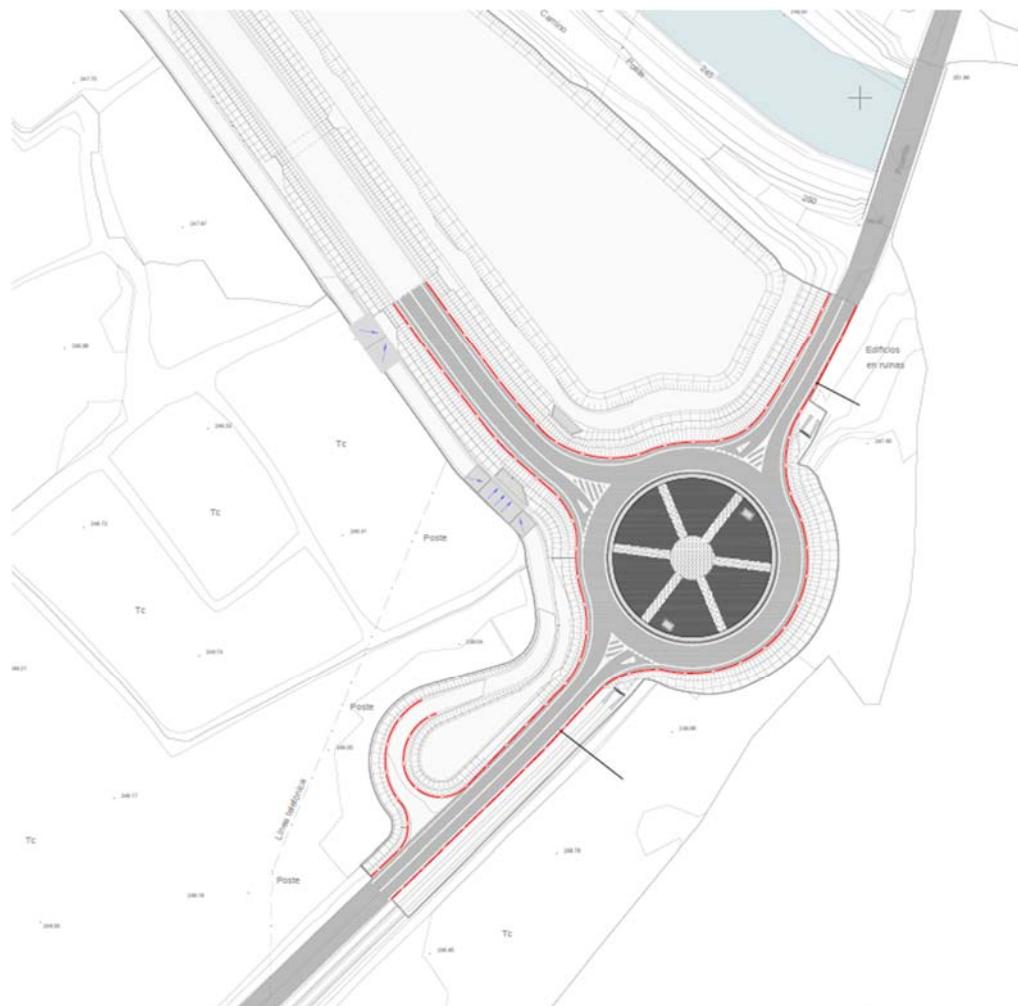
Planta General (Plano 8.1.1. del Proyecto)
